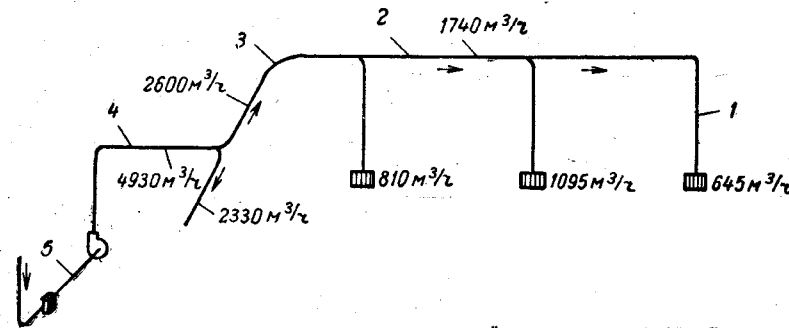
Расчетная схема приточной системы вентиляции
